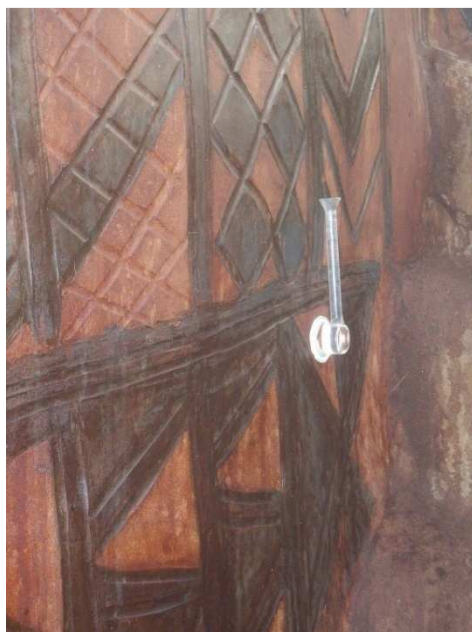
Essai à la pipe en verre sur un enduit traditionnel
